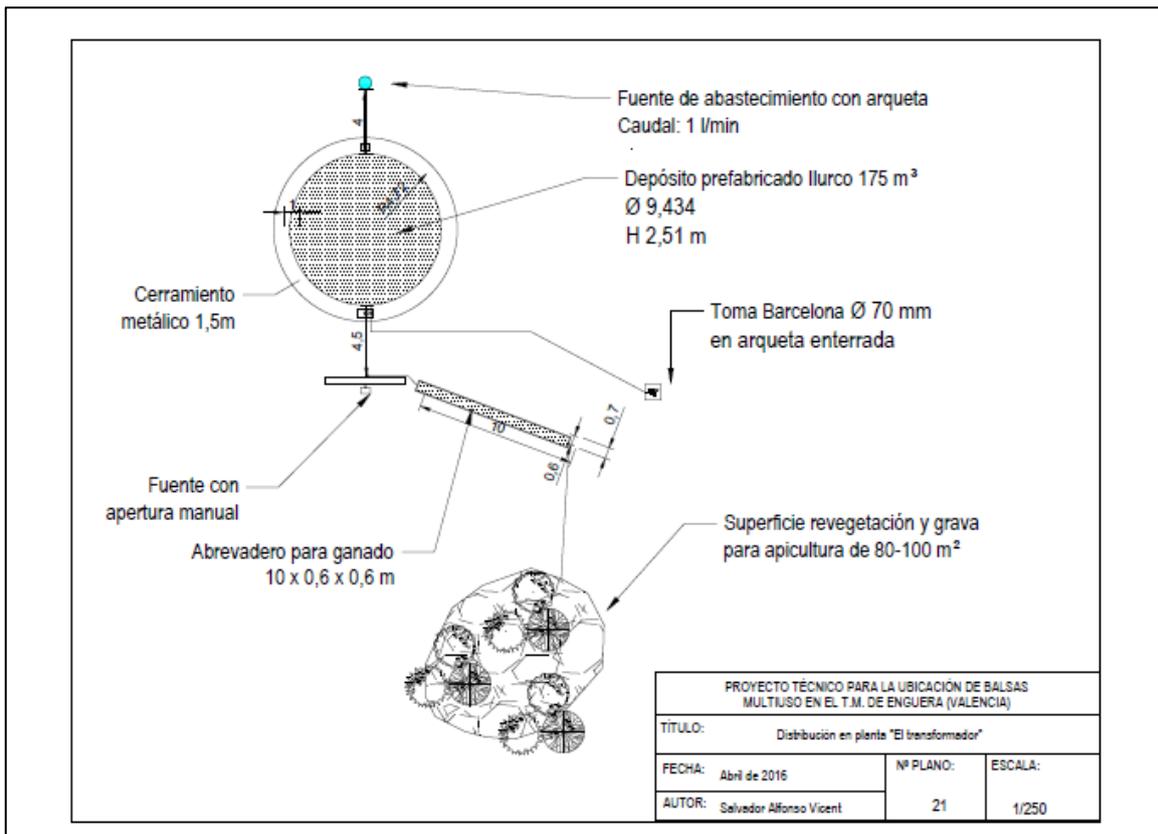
Plano de distribución en planta “El transformador”.Fuente: elaboración propia con Autocad
